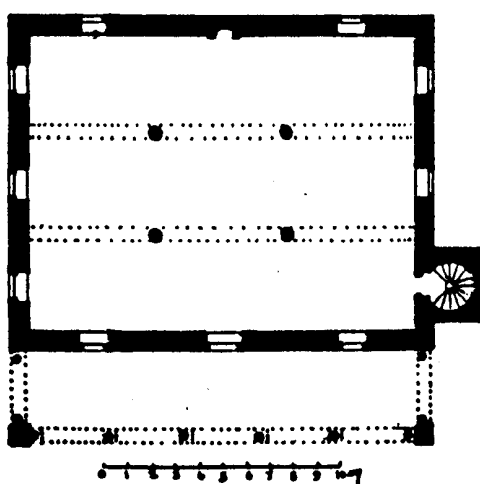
مسقط أفقي لجامع في موزامبور بالبنتغال
